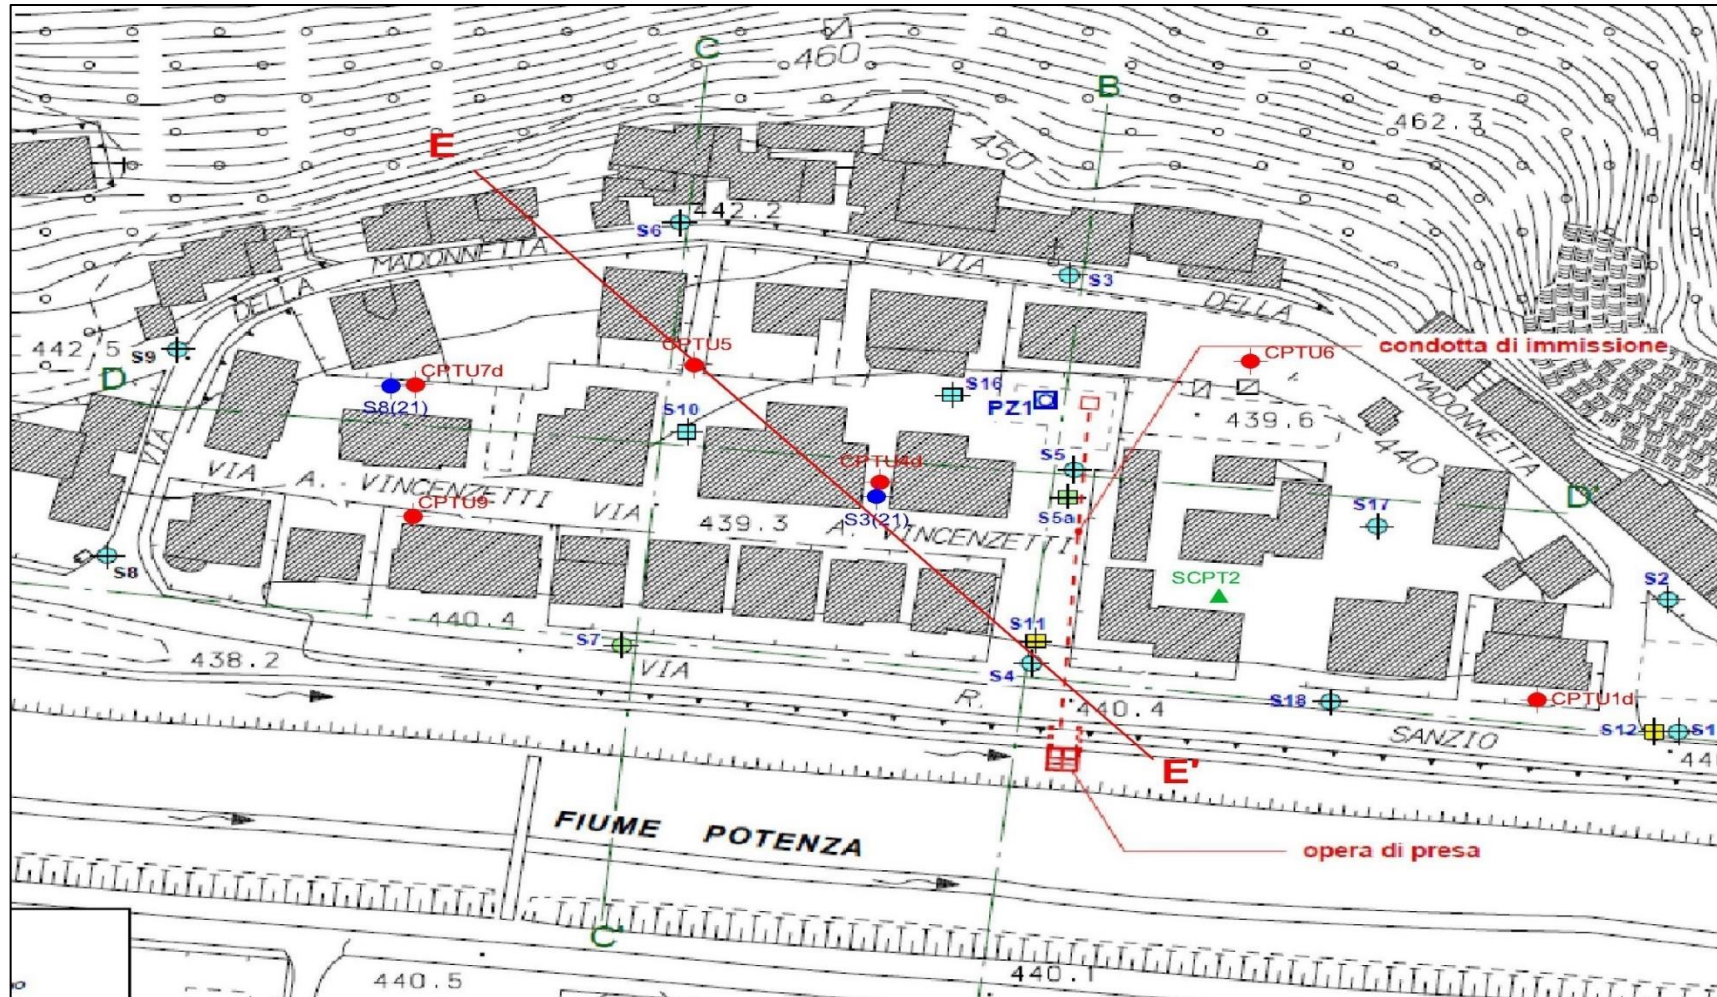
Rappresentazione sezione E-E' in planimetria
